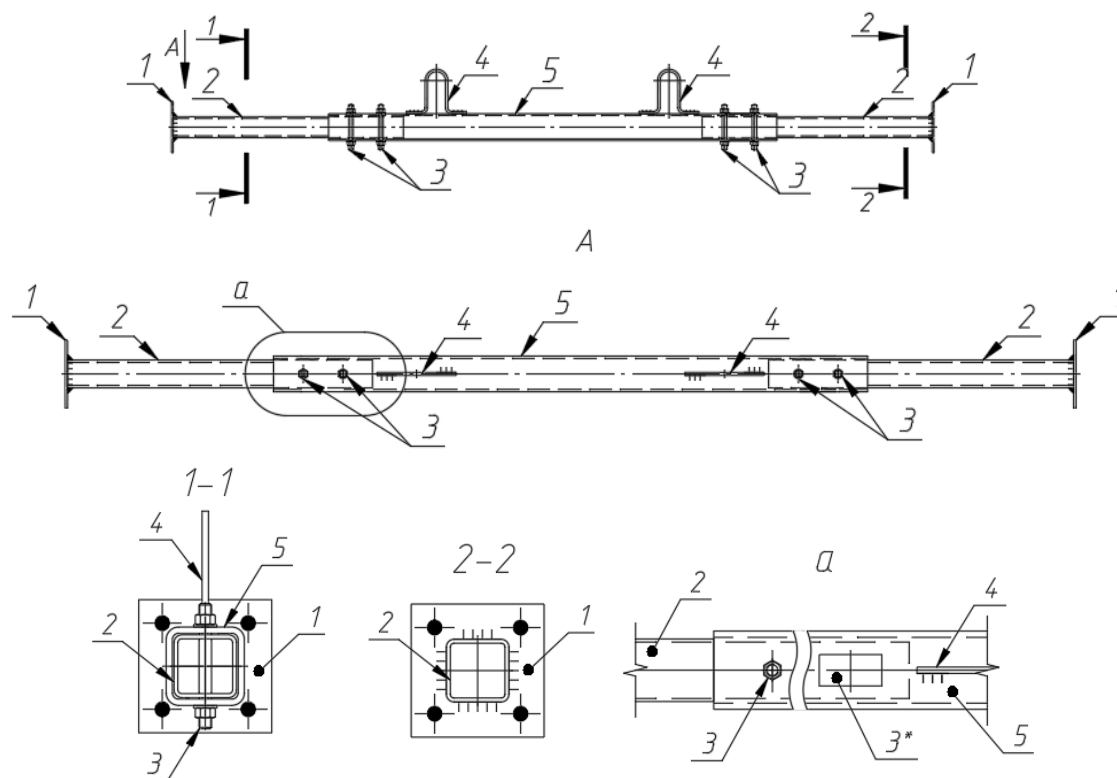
Устройство для временного усиления кирпичных стен при демонтаже перекрытий: 1 – опора; 2 – подвижная часть; 3 – шпильки для фиксирования подвижной части; 4 – монтажная петля; 5 – базовая часть
